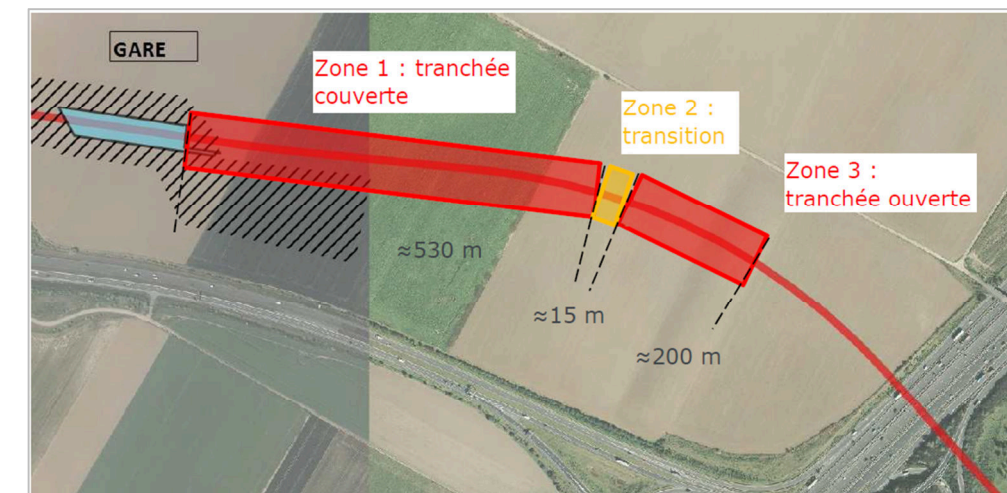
Vue en plan du secteur en tranchée de la zone de transition de Gonesse
